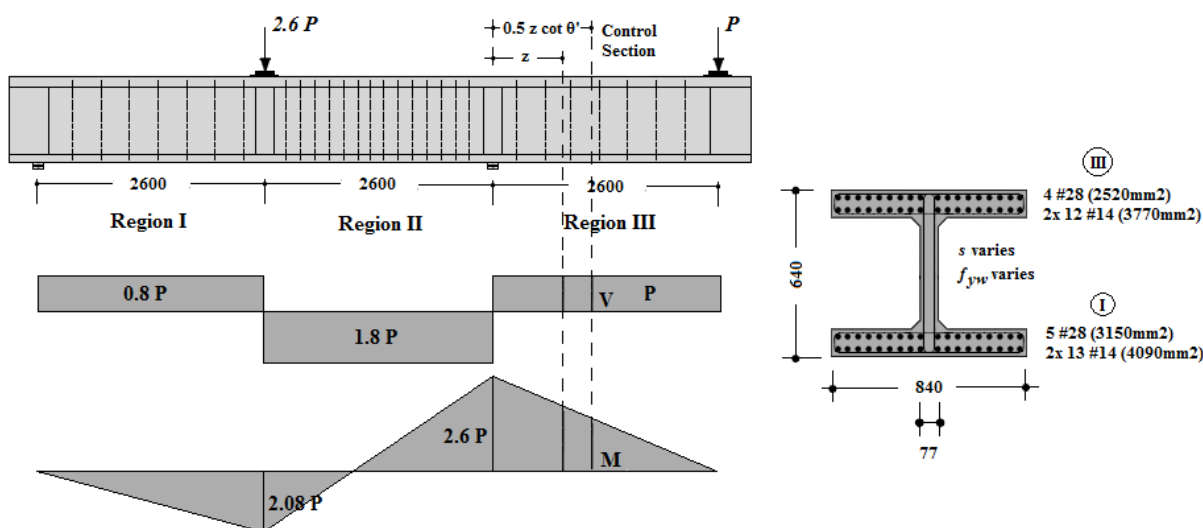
Geometria e disposição das armaduras das vigas testadas por Reineck.
